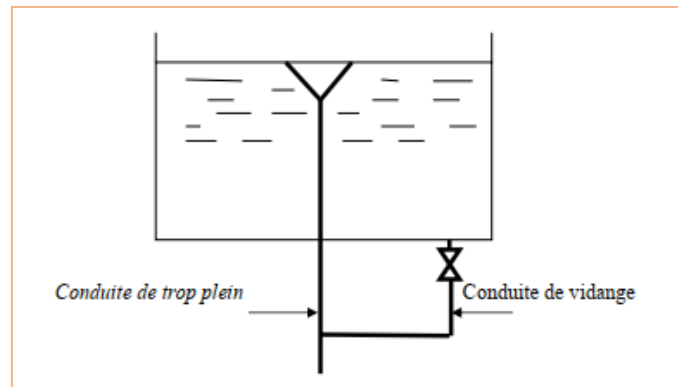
Illustration conduite de trop plein et de conduite de vidange
